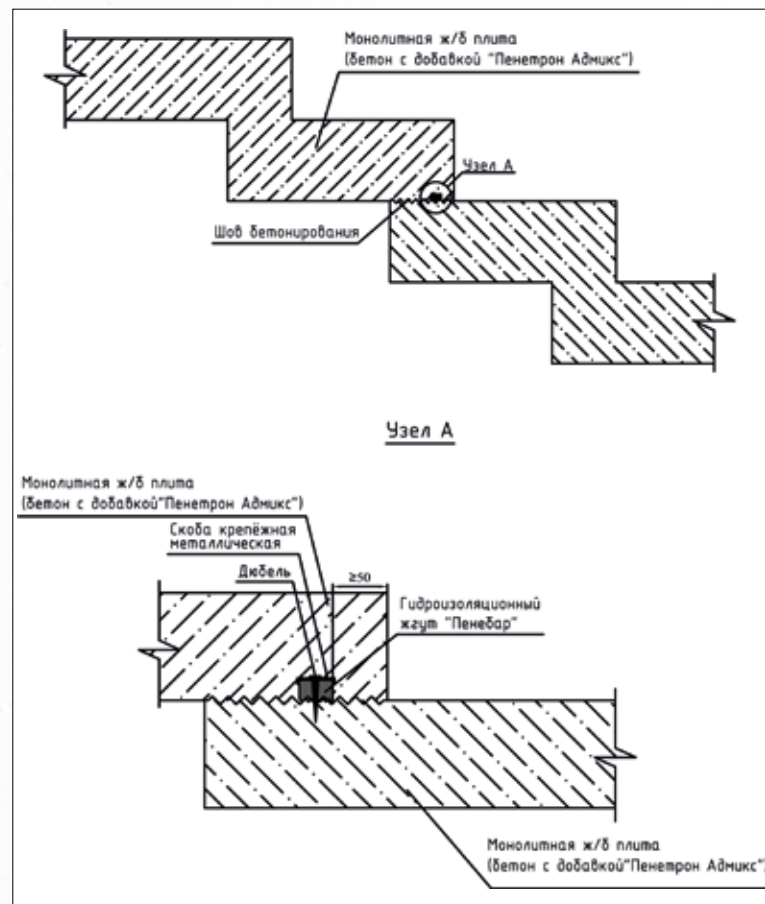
Схема устройства гидроизоляции ограждающих элементов конструкции и швов бетонирования в трибунных перекрытиях при их возведении
